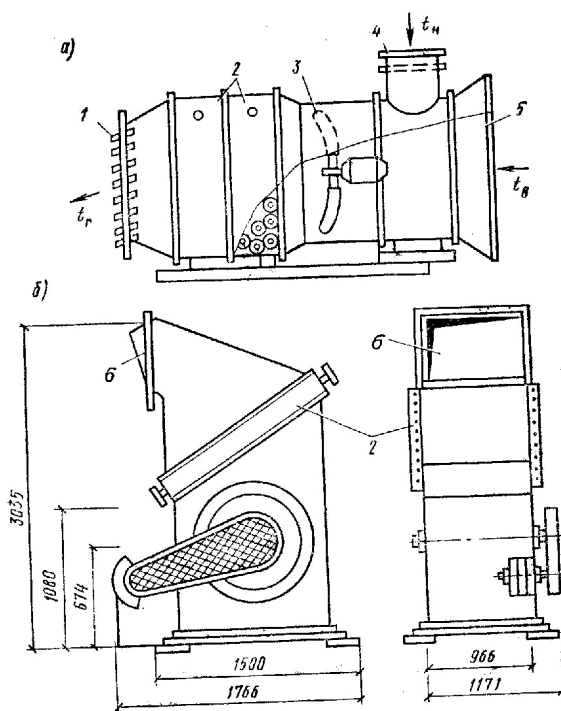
Воздушно-отопительный агрегат: 1 – направляющая решётка; 2 – калорифер; 3 – осевой вентилятор; 4 – забор наружного воздуха; 5 – забор внутреннего воздуха
